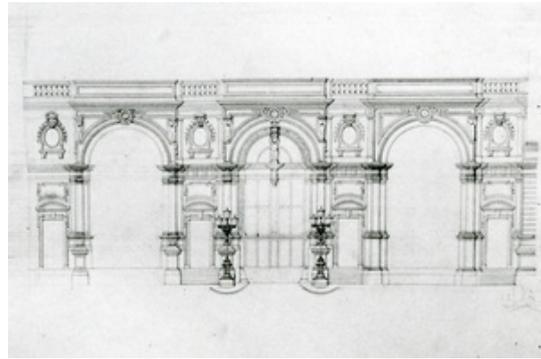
Skizze 20c, Fassadendetail zu 18
